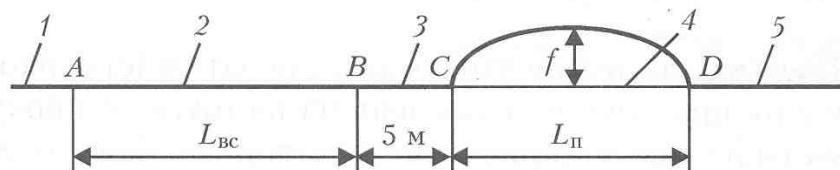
Схема вигину пліті перед зварюванням при виготовленні її методом часткового розкріплення: 1 – закріплена ділянка пліті, на якій знаходиться ПРЗМ; 2 – вварювана вставка з ослабленими клемами; 3 – пряма ділянка пліті, що приварюється; 4 – ділянка CD зі знятими клемами і вигином; 5 – закріплена пліть; А – перший, В – другий стик зварювання; f – стріла вигину пліті; $L_{вс}$ – довжина ділянки вигину; $L_{пв}$ – довжина вставки, що вварюється
